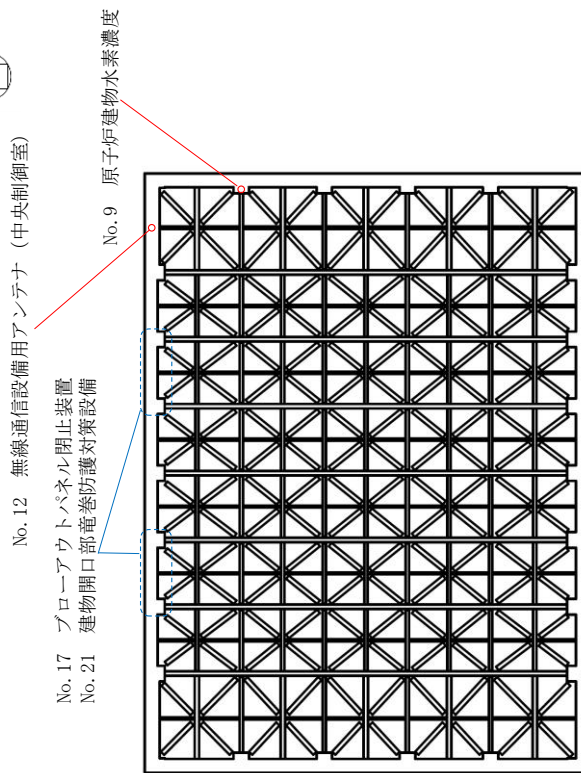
(3) 影響検討対象設備の概略配置図 (平面図 EL. 63.500m)
